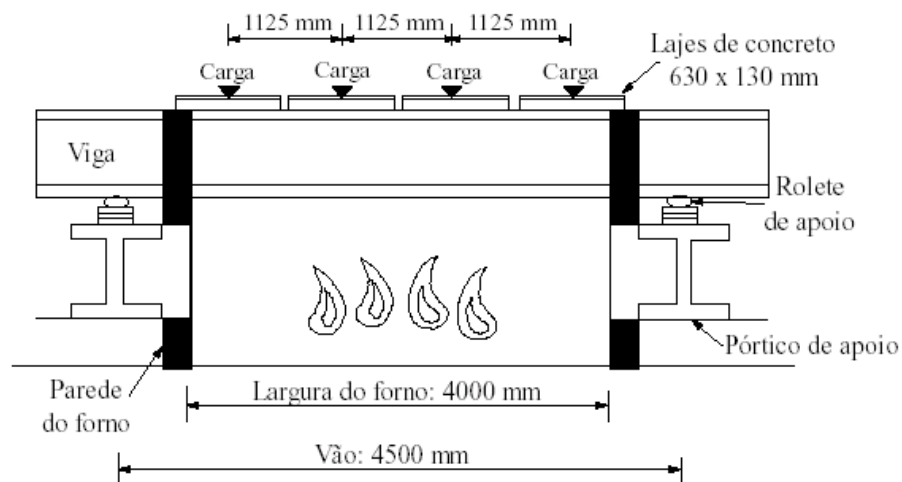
Ensaio-padrão de vigas: cargas e condições de apoio.
